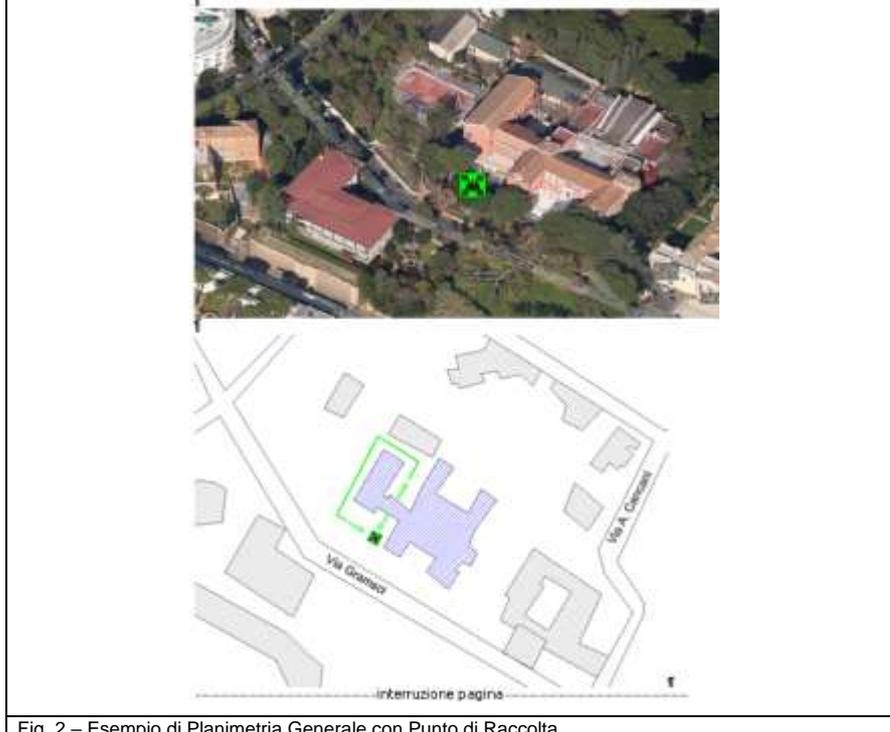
Esempio di Planimetria Generale con Punto di Raccolta
